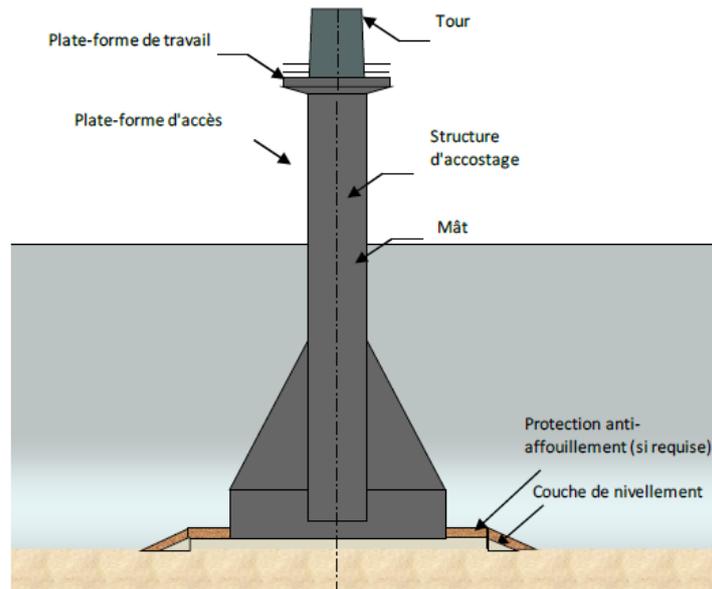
Schéma d'une fondation à structure embase gravitaire
